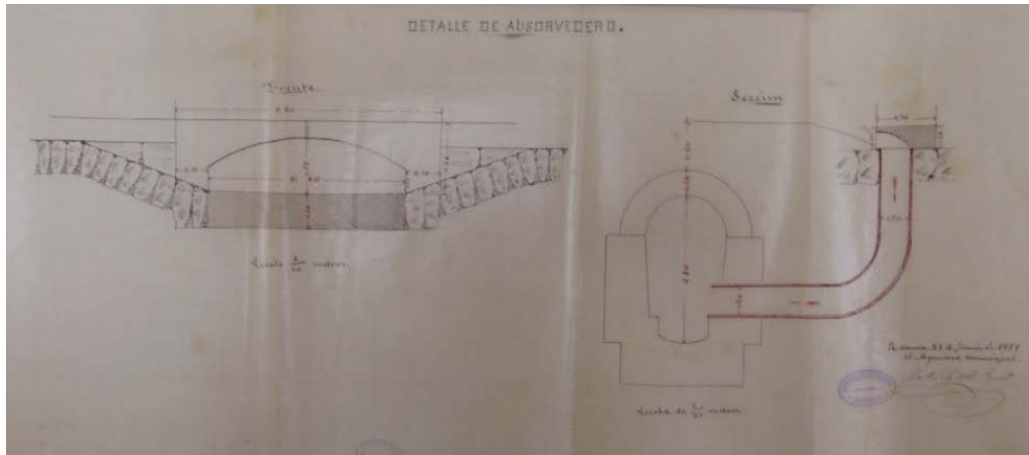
Detalle de los absorvederos de la sección de alcantarillado de la calle San Torcuato.
